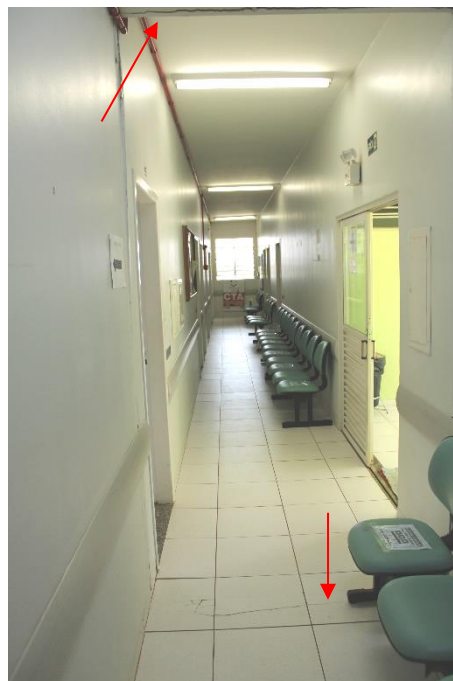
Vista do corredor, destacando fissura em revestimento cerâmico (piso).
